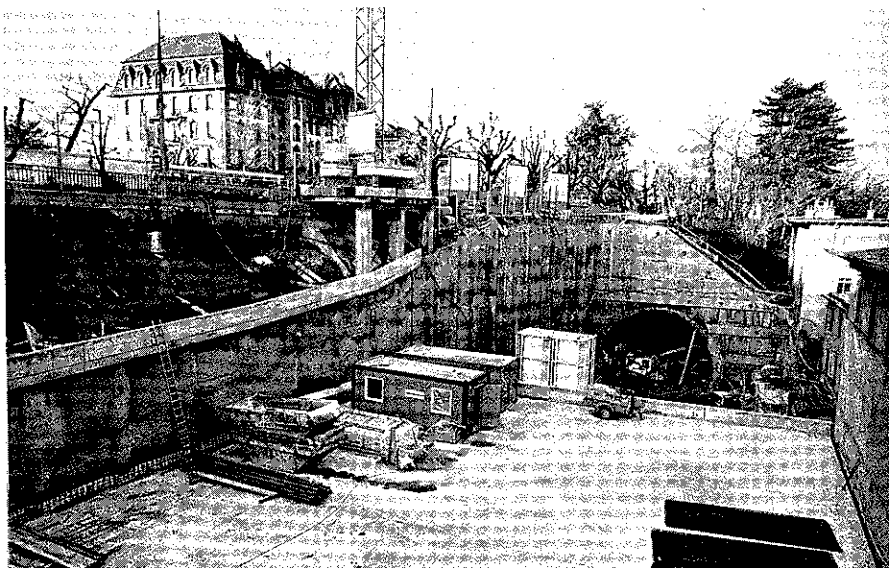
Station de Lausanne-Flon: dalle de couverture et attaque Flon du tunnel.
